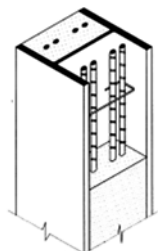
Arranjo de pilar misto de aço e concreto fornece proteção de 60 minutos. Os estribos devem soldados à alma dos perfis
